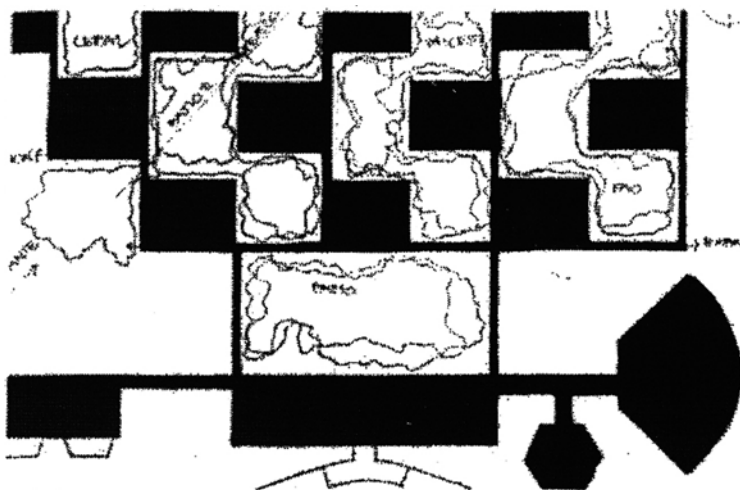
Planta de la Propuesta de Concurso para el edificio de la CEPAL del equipo de I. Santa María, F. Bertrand y M. Dávila. Fuente: biblioteca de la CEPAL.
